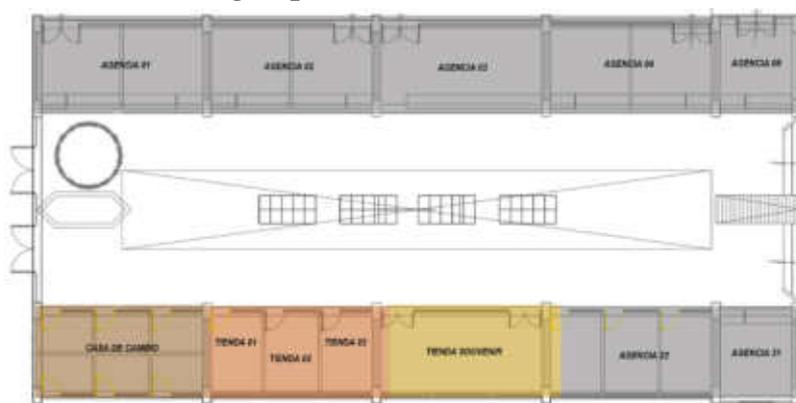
Planta de Distribución del Primer Nivel del bloque “A”.
